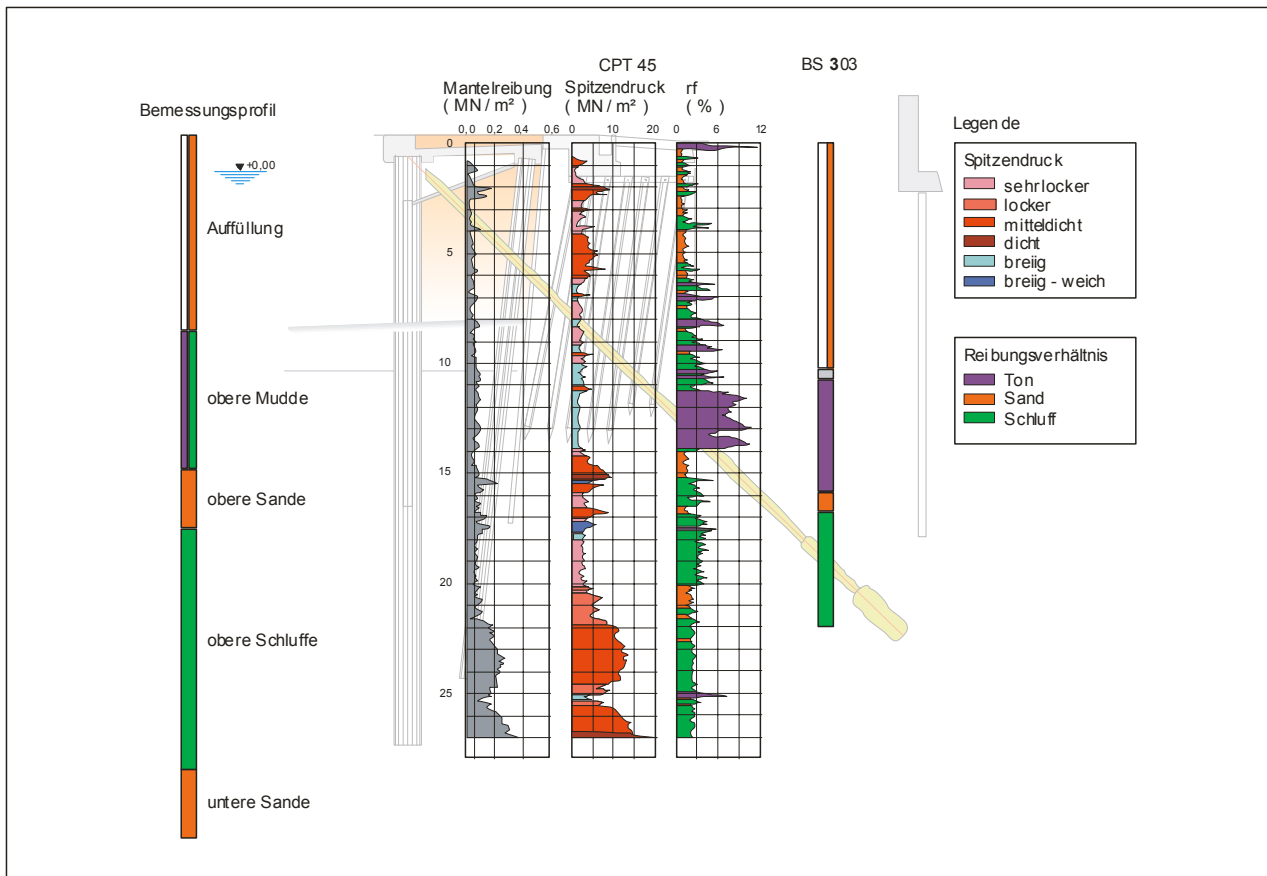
Querschnitt mit Baugrundaufschlüssen.
